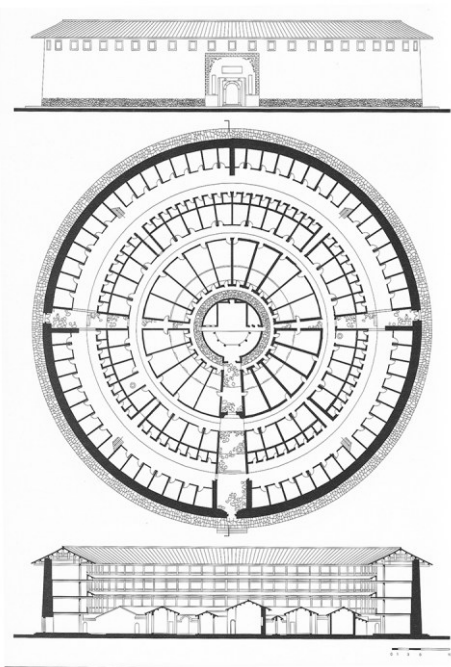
Prospetto, pianta e sezione del *Cheng Qi lou tulou*. (Greco, 2003: p. 58)
